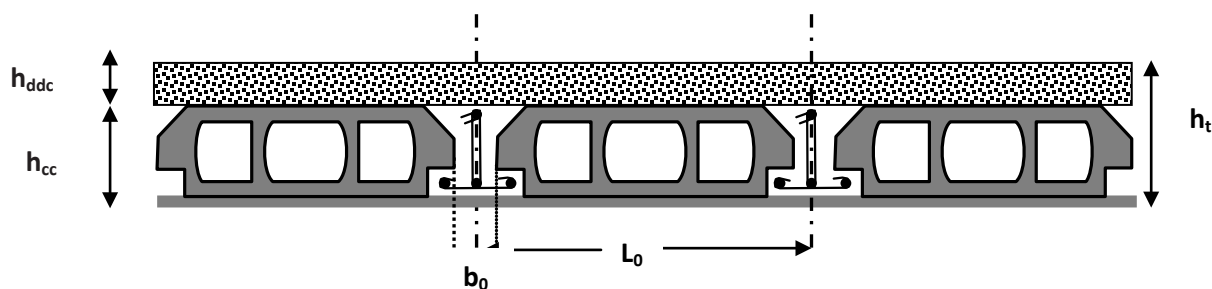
Coupe transversale sur un plancher à corps creux.
